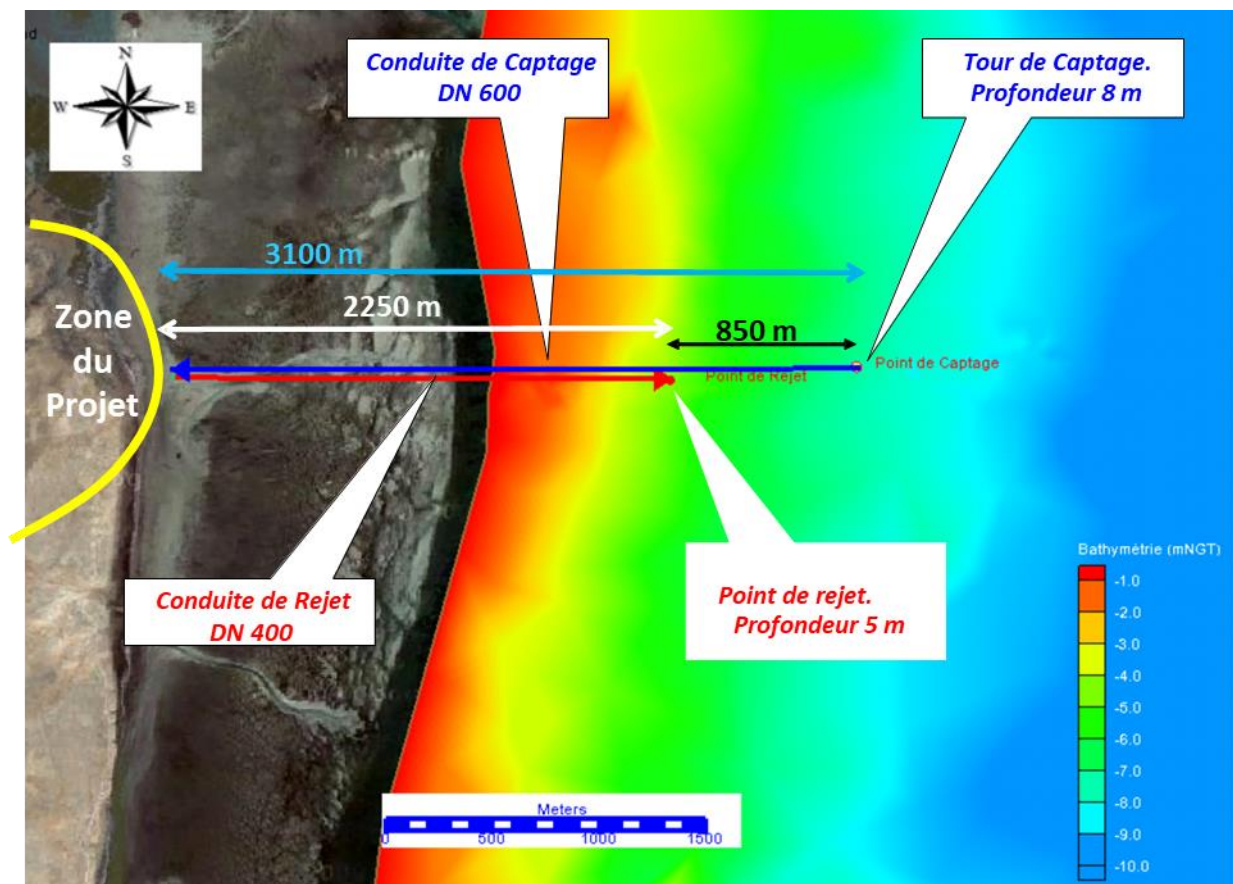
Plan d'implantation d'ensemble des conduites en mer
